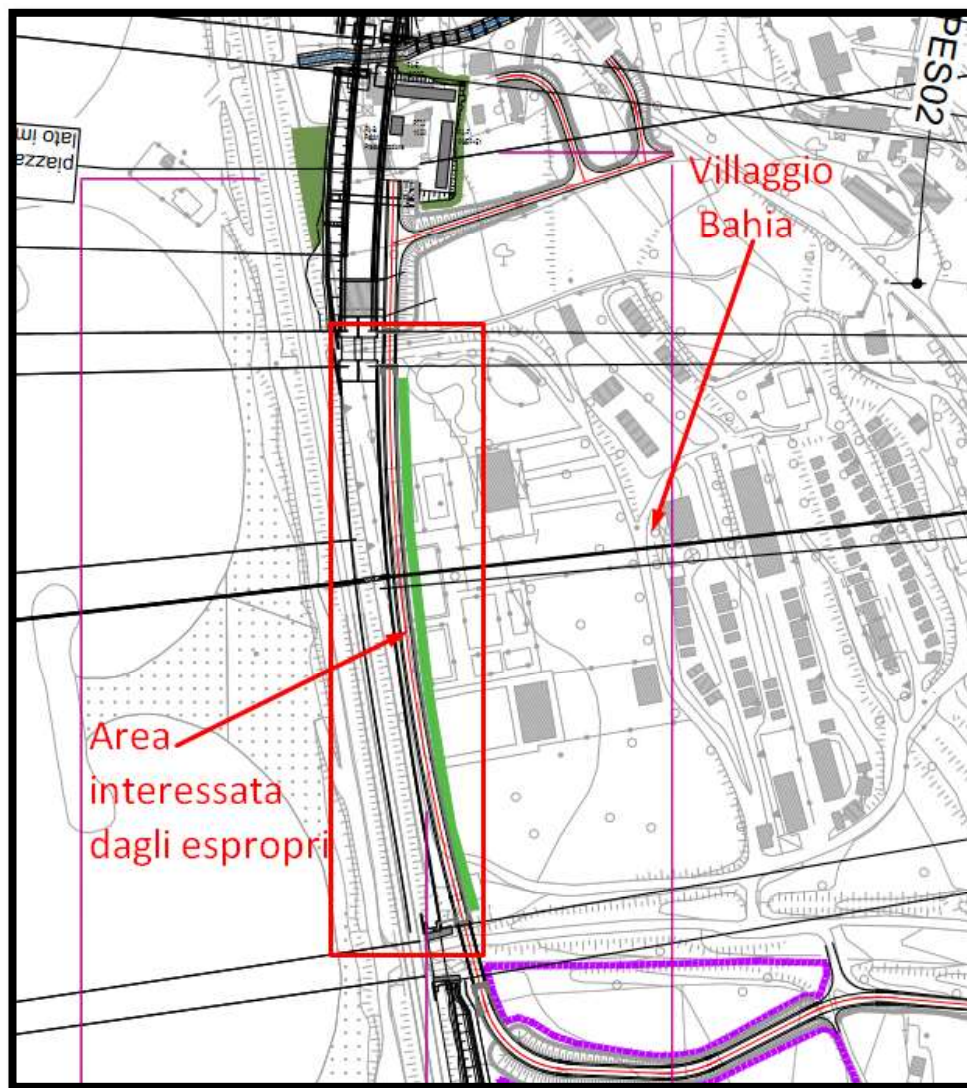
Stralcio progetto in variante – Revisione gennaio 2024
